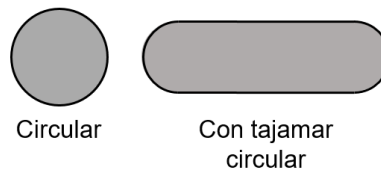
Tipos de pilas consideradas para el análisis de socavación.
